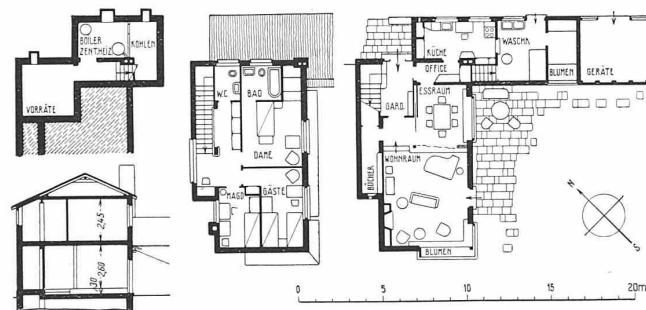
Grundrisse und Schnitt 1 : 400 des Hauses Ritter.
